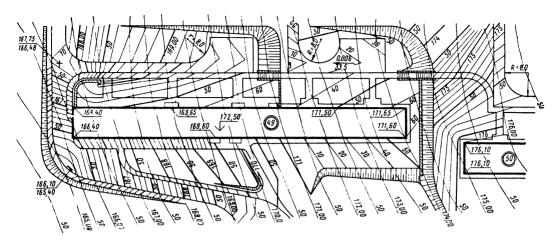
Вертикальная планировка при посадке здания поперек уклона
